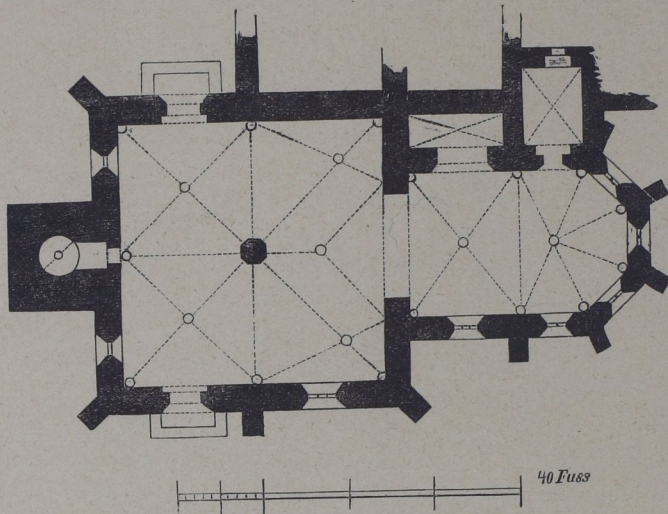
Grundriss der ehemaligen Servitenkirche in Slup.
